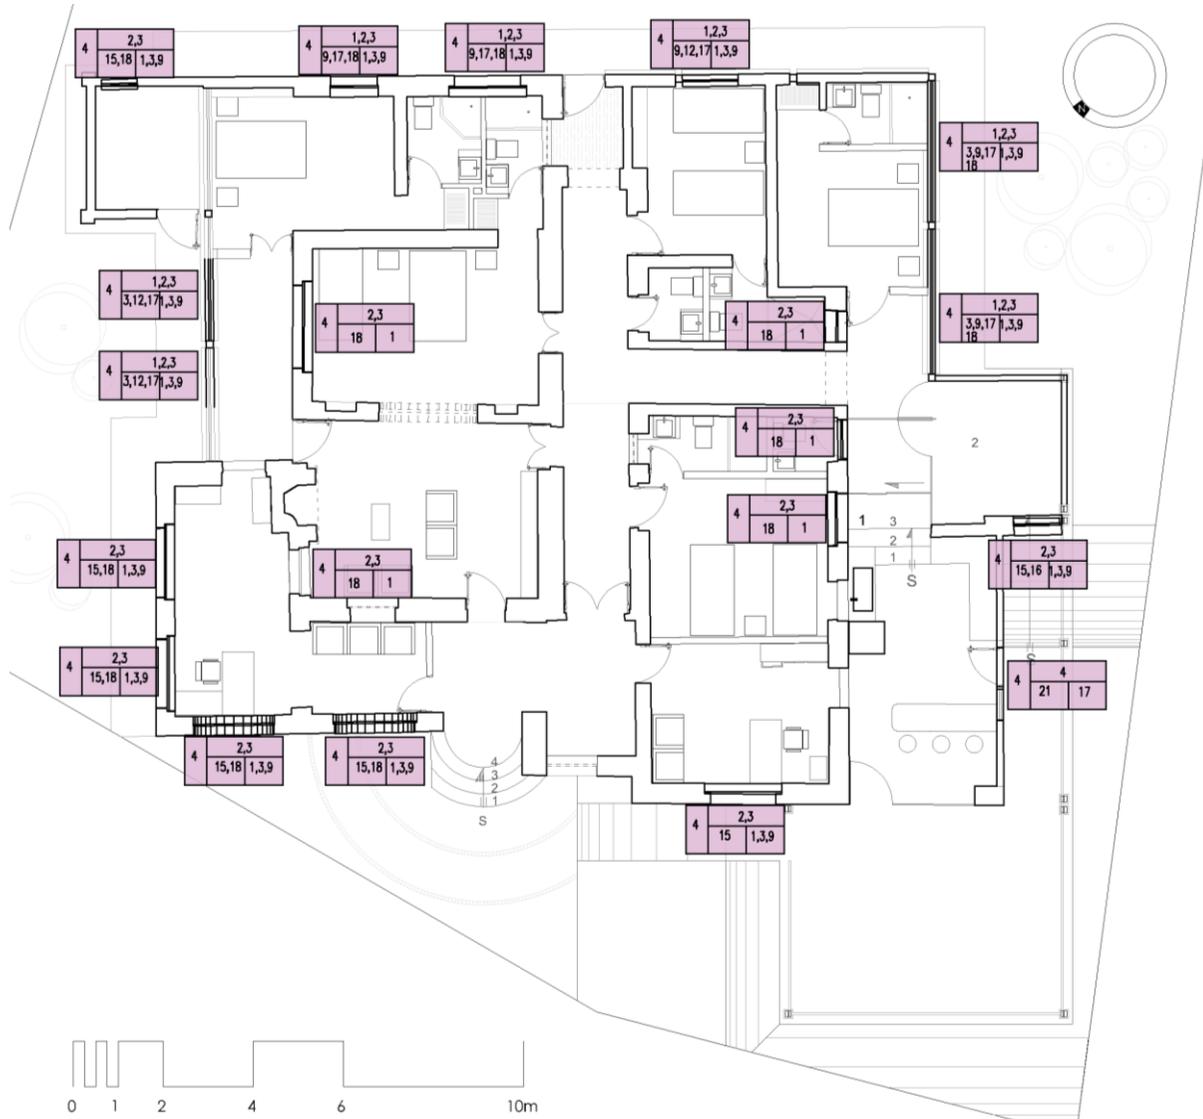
Planta de deterioros de muros, Fuente: Elaboración Propia
